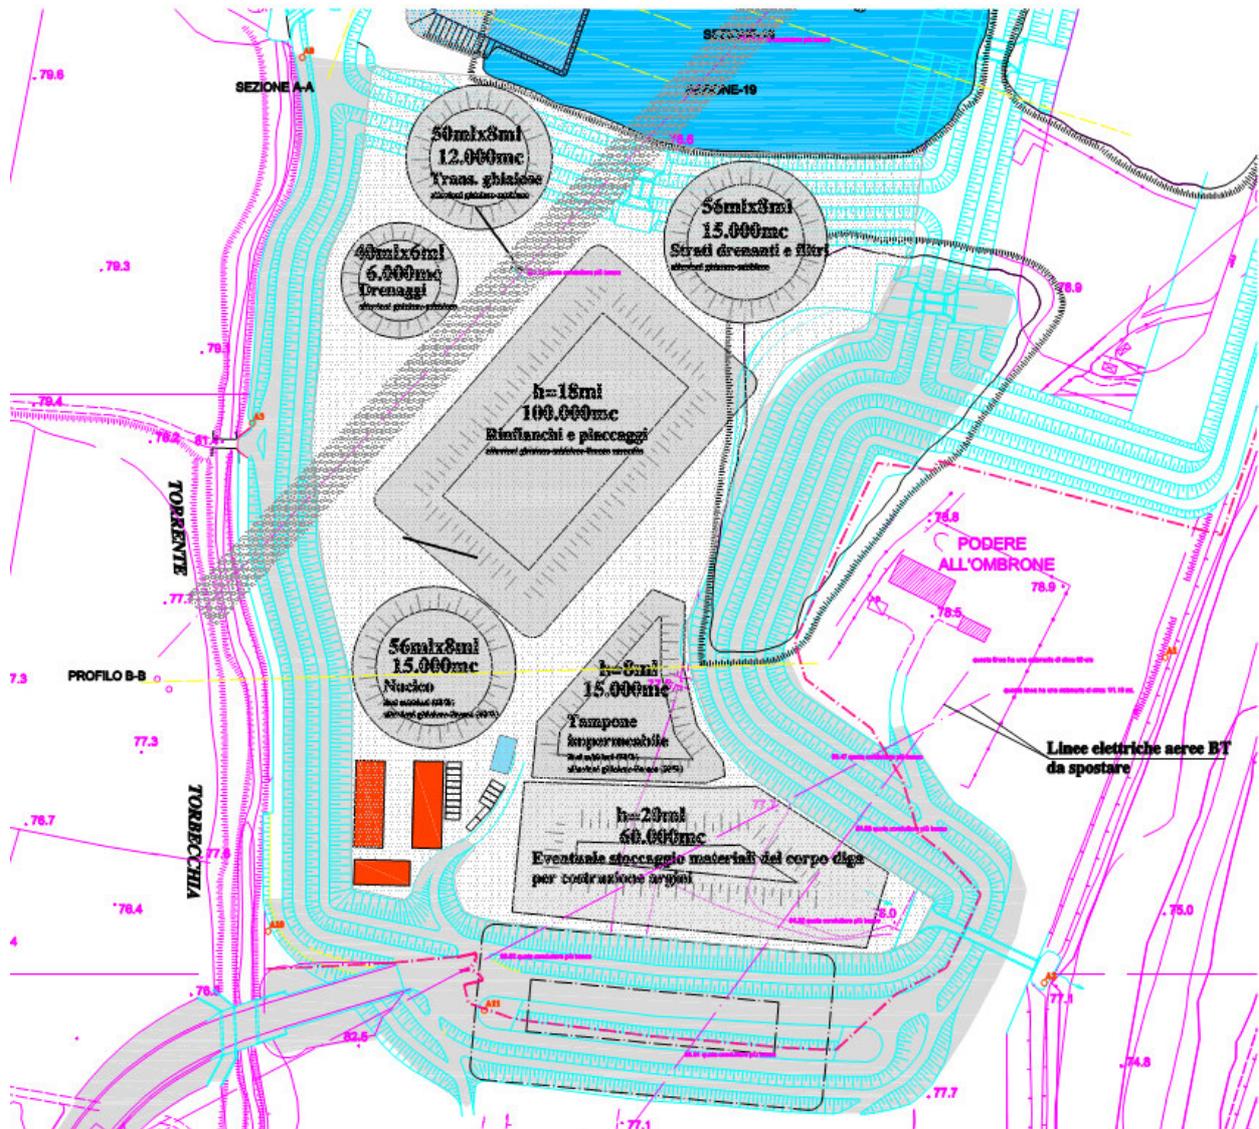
PLANIMETRIA IMPIANTO DI SELEZIONE INERTI ALL'INTERNO DELL'AREA DI CASSA
